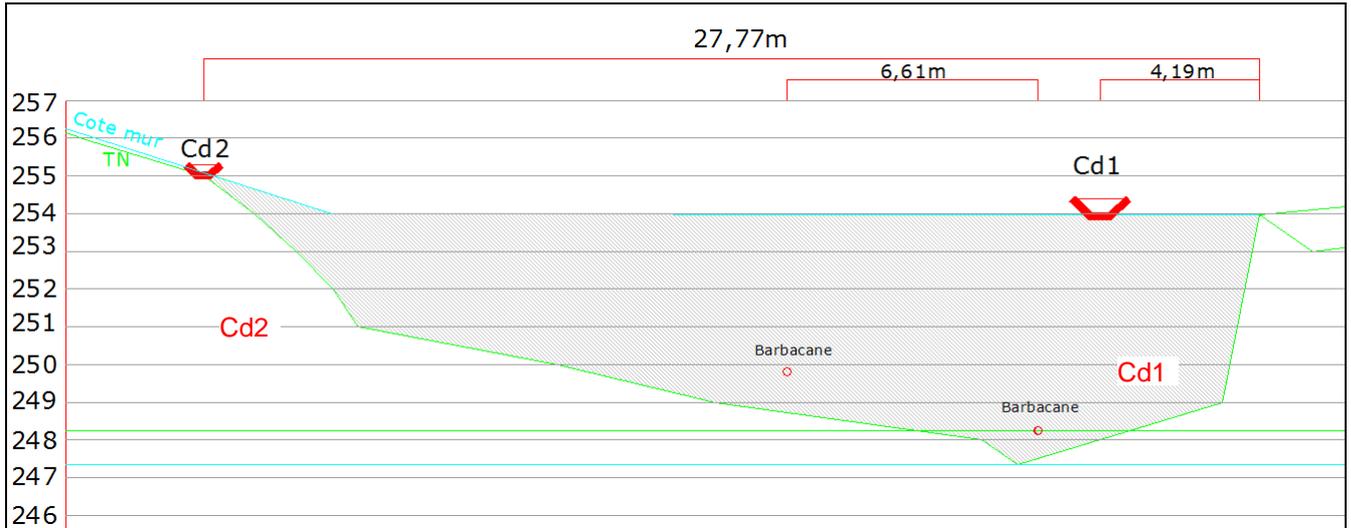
Implantation des ouvrages sur le mur de soutènement (vue depuis l'aval)
